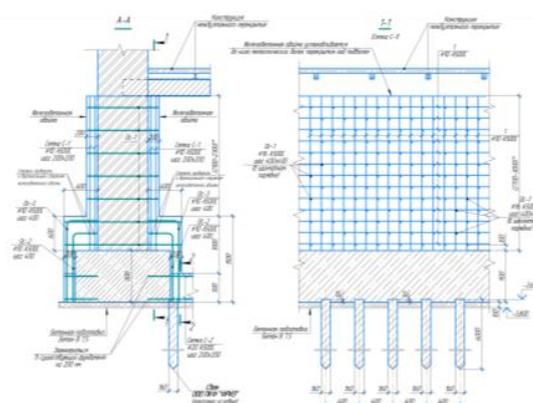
Усиление фундаментов, стен подвала и ядра жесткости
